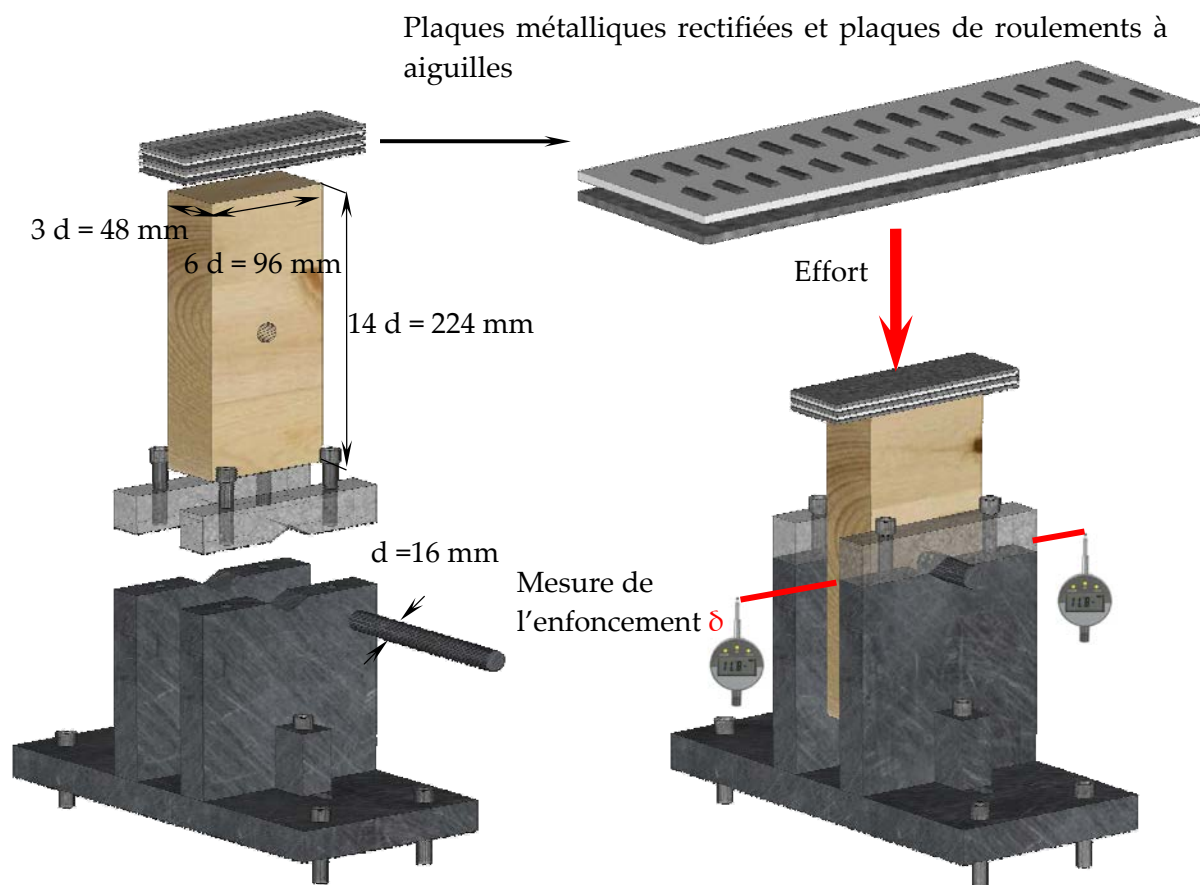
Montage d'essais et dimensions des éprouvettes d'enfoncement avec des tiges $d = 16 \text{ mm}$ [57].
